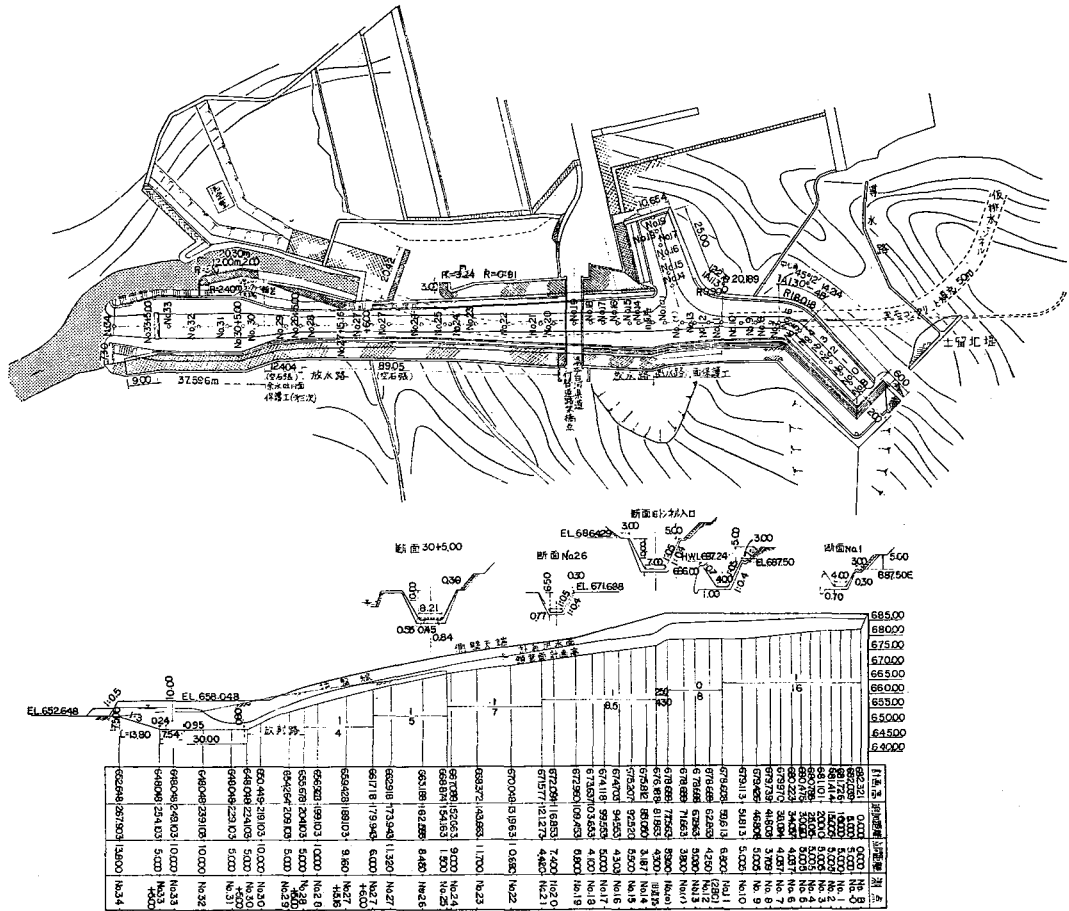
羽鳥ダム余水吐平面図および縦断面図
